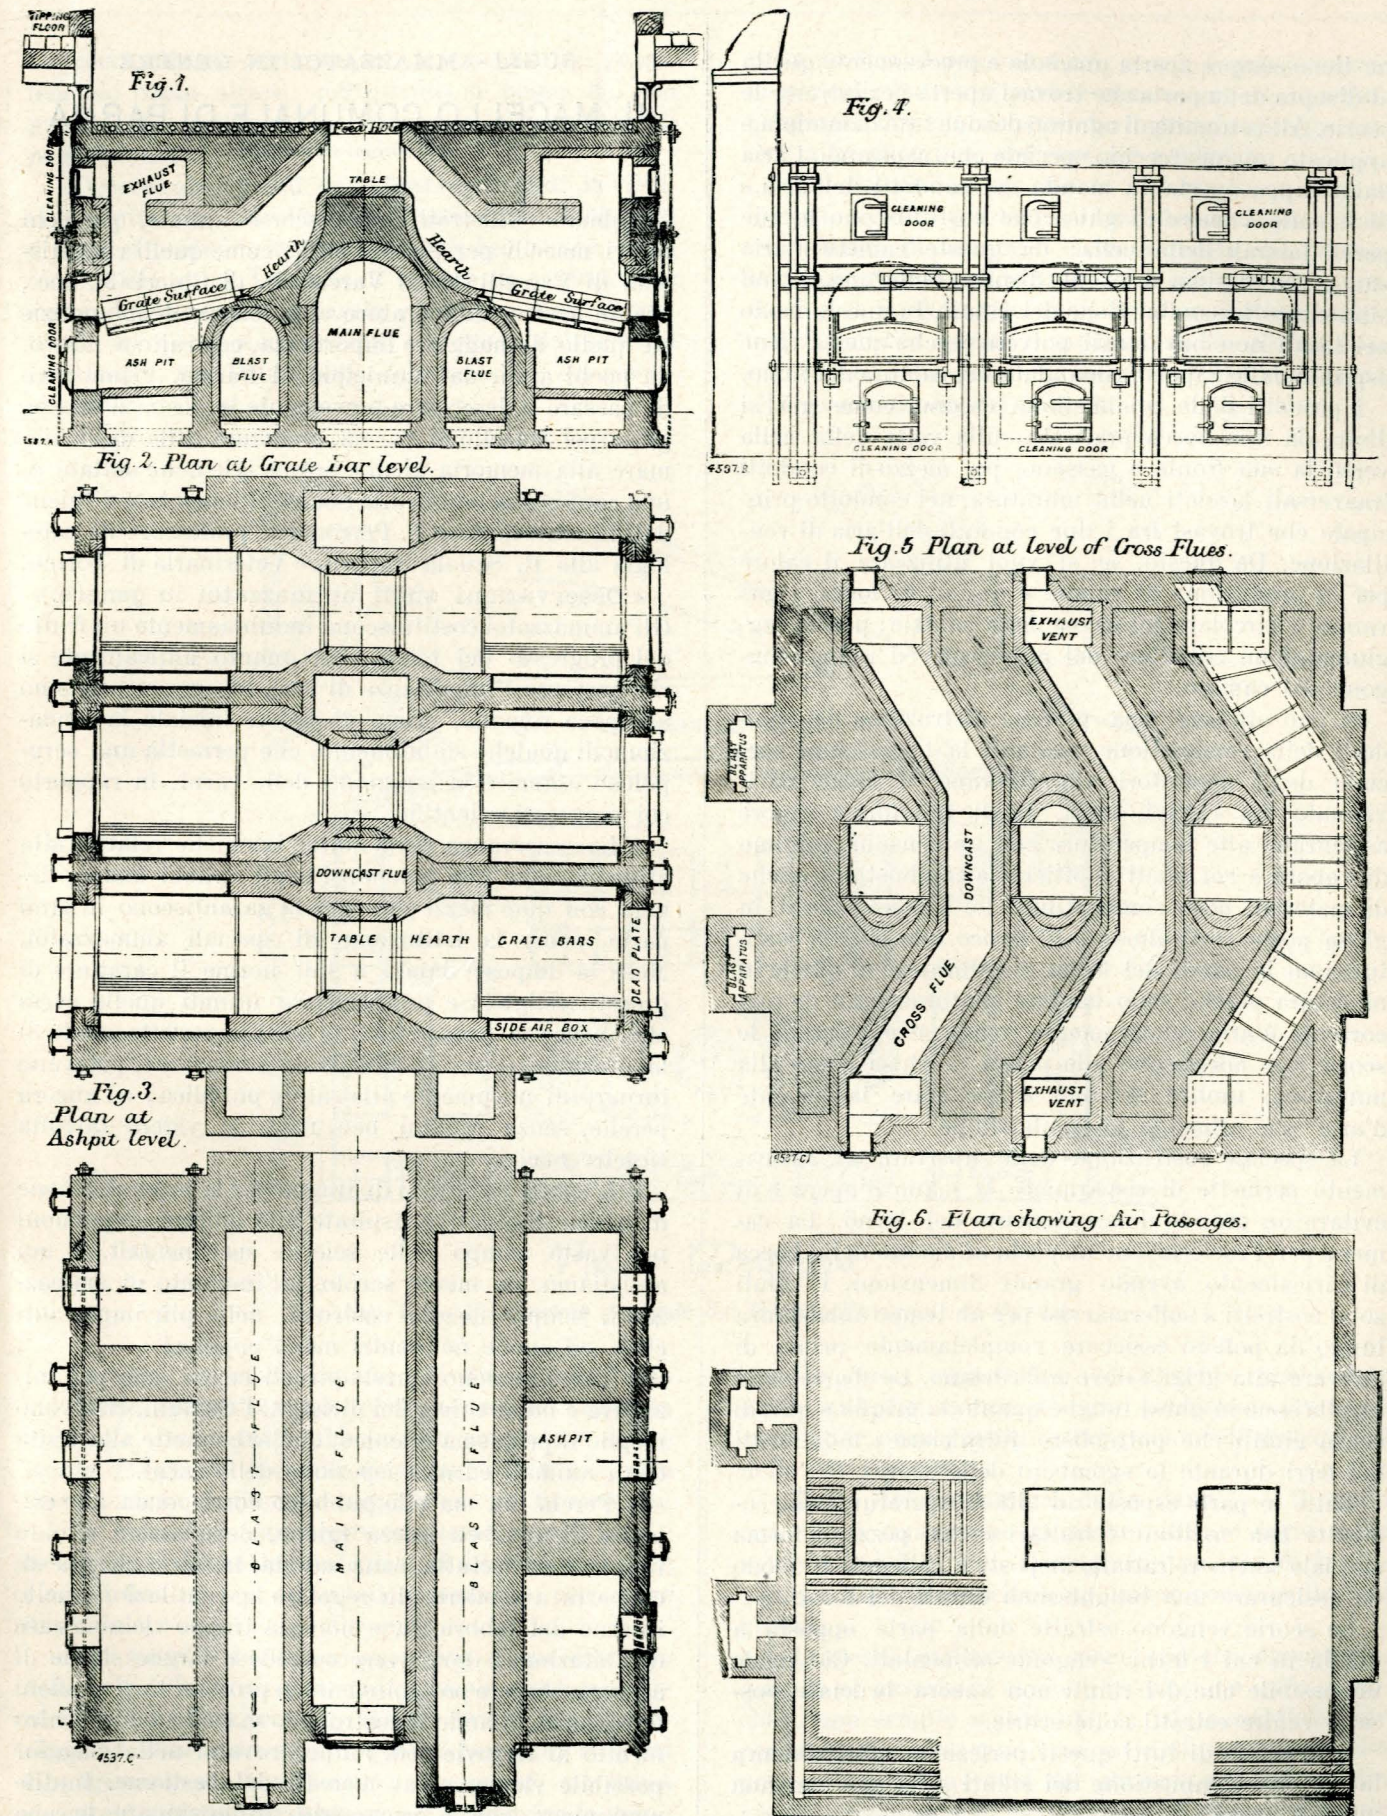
Sezione verticale attraverso la bocca di caricamento delle immondizie.
